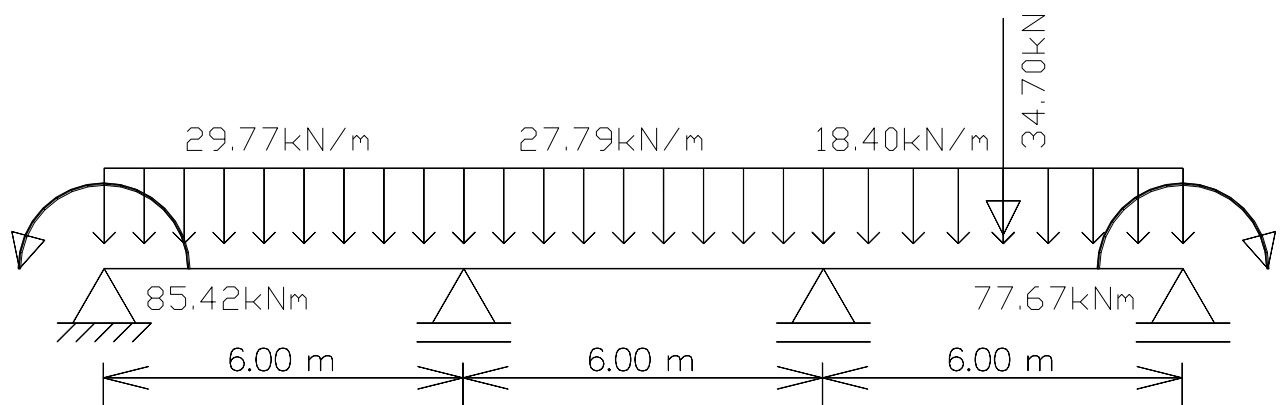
Esquema estático e carregamento da viga V3(V4).
